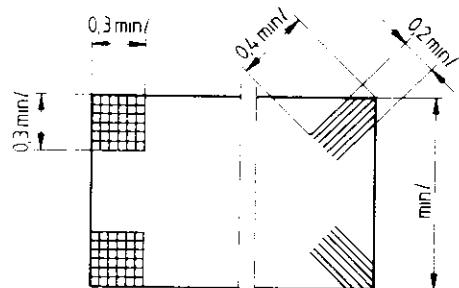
Rechtwinklige und schräge Eckbewehrung, Oberseite
